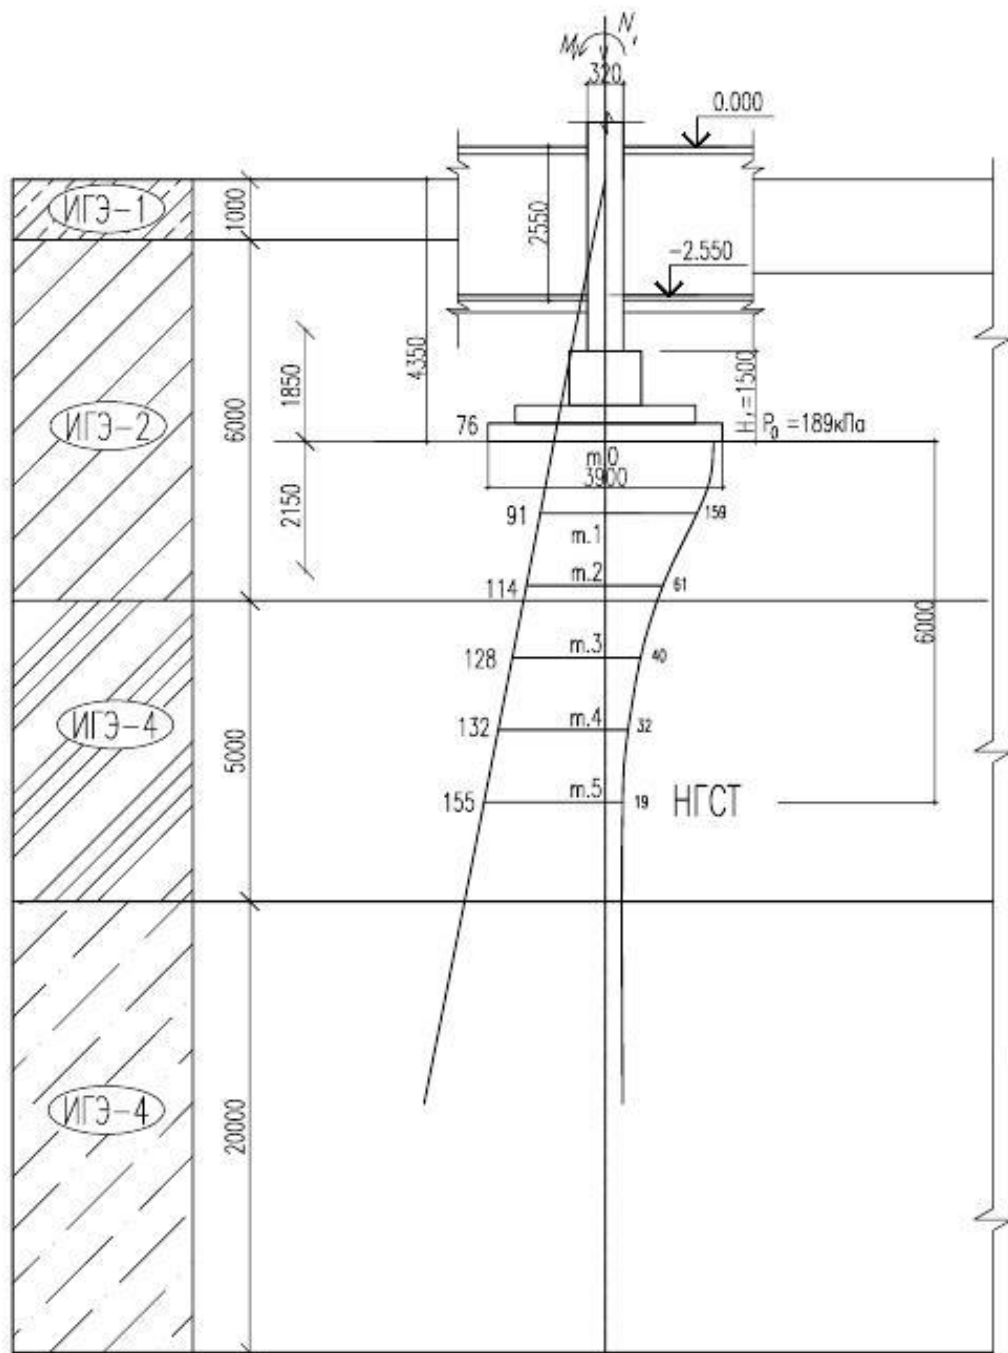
К расчету осадки фундамента в сечении I-I.
